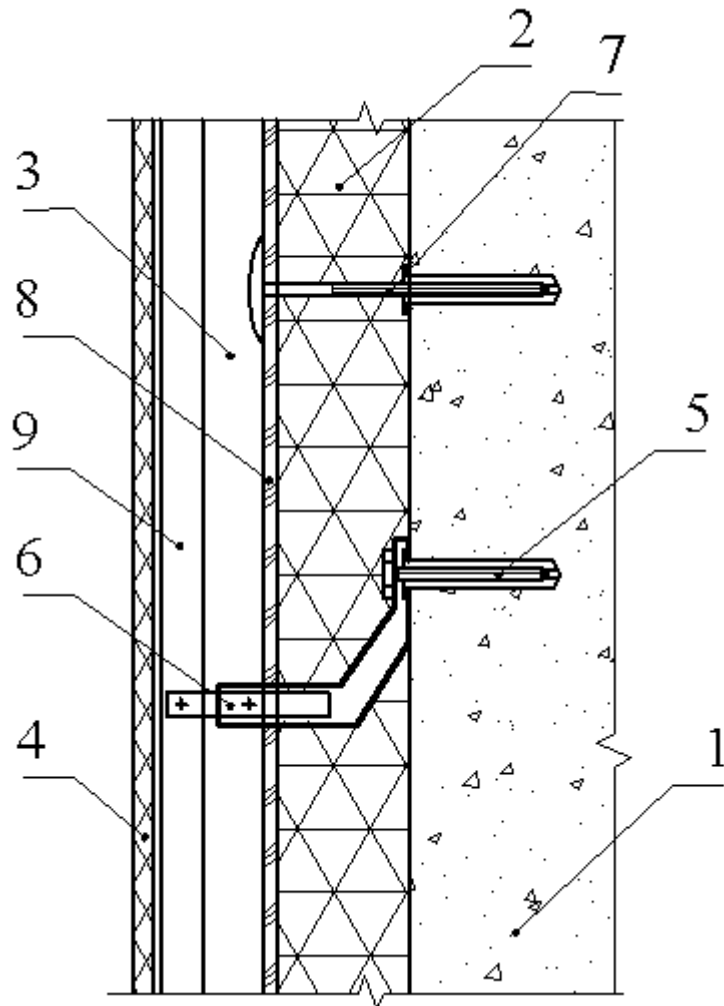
Схема наружной стены с теплоизоляцией и отстоящим фасадным экраном (вентилируемый фасад)
